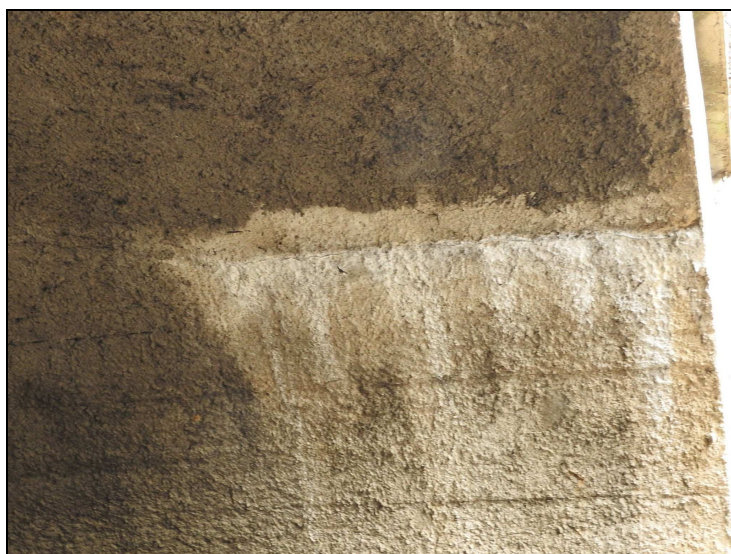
Konstrukce K 01 – čelní zeď vlevo – vodorovná trhлина s výluhem
